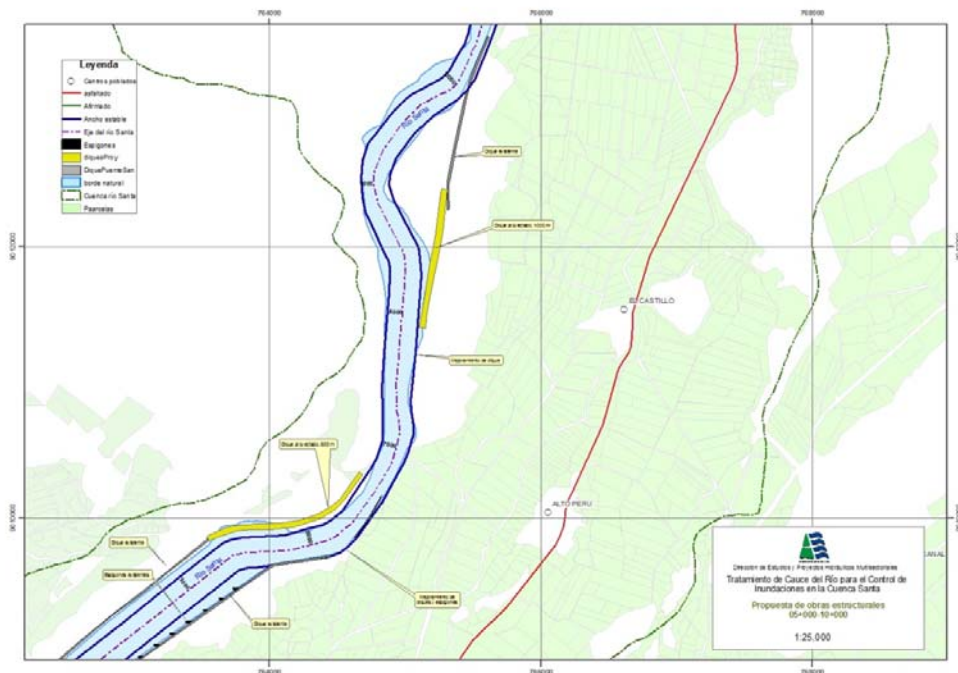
Estructuras proyectadas en el tramo 5-10+000
